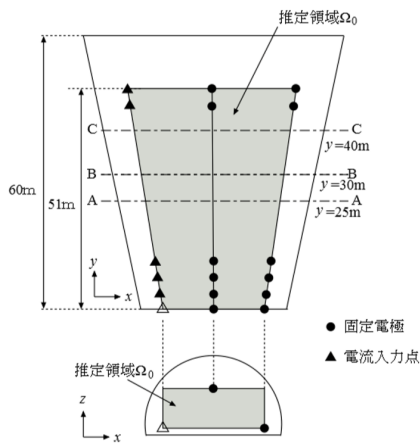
解析モデル  $x-z$  平面図,  $x-y$  平面図
